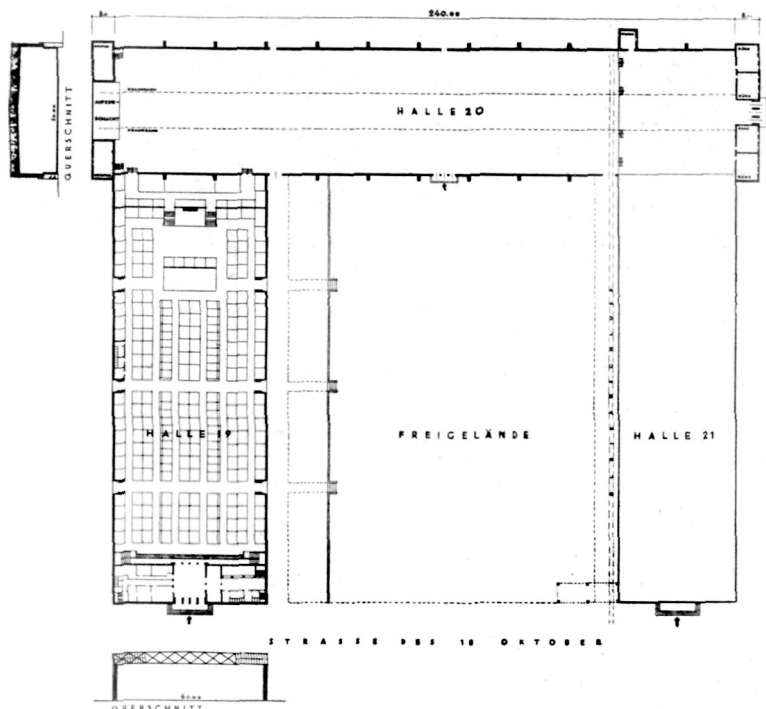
Baummesse Leipzig, Halle 19 u. 20. Grundriß
